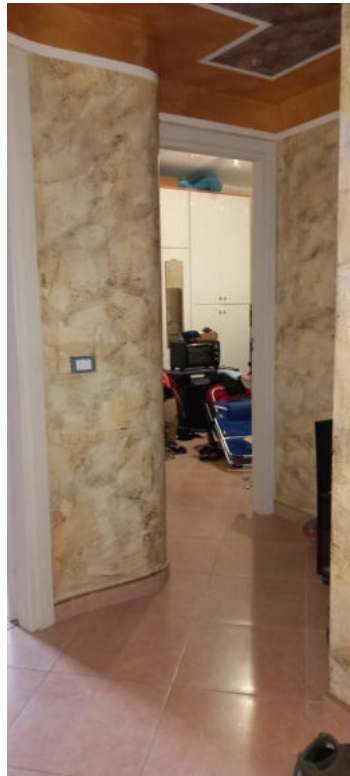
vista del disimpegno e foto 13: vista della camera 3
